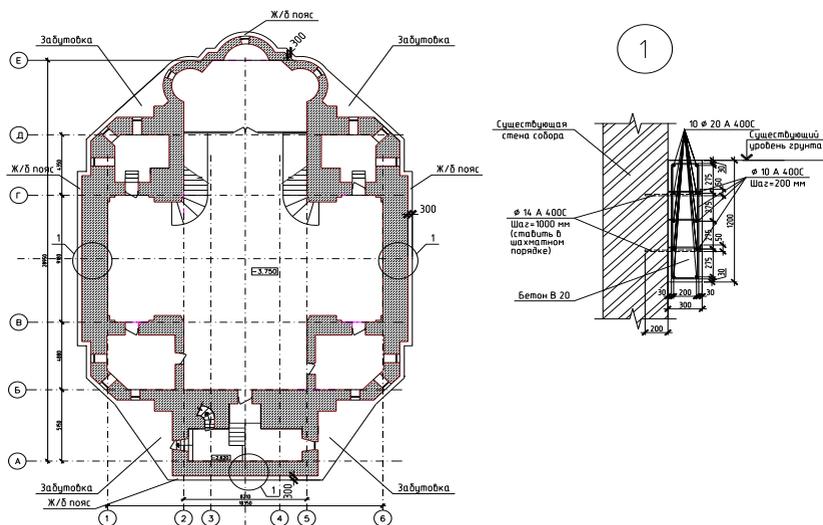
Схема расположения замкнутого монолитного железобетонного пояса по верху фундамента Собора Святого Равноапостольного князя Владимира
